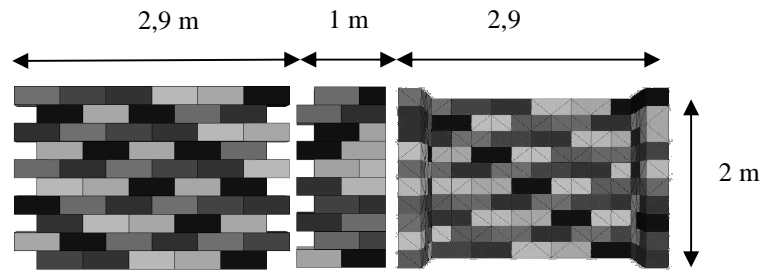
a) mur principal ; b) mur de refend ; c) maillage complet
